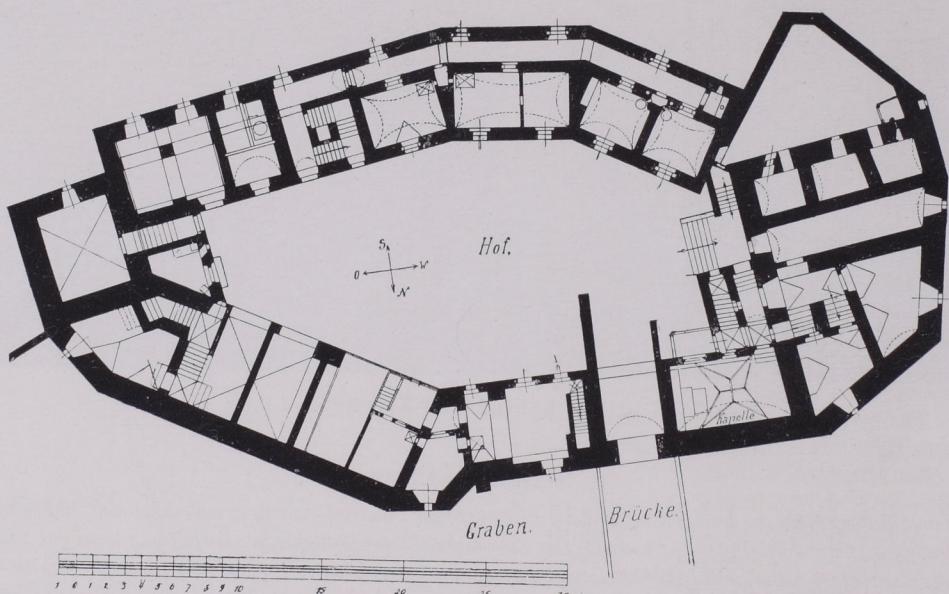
Schloß Golling, Grundriß 1:400 (S. 83).
